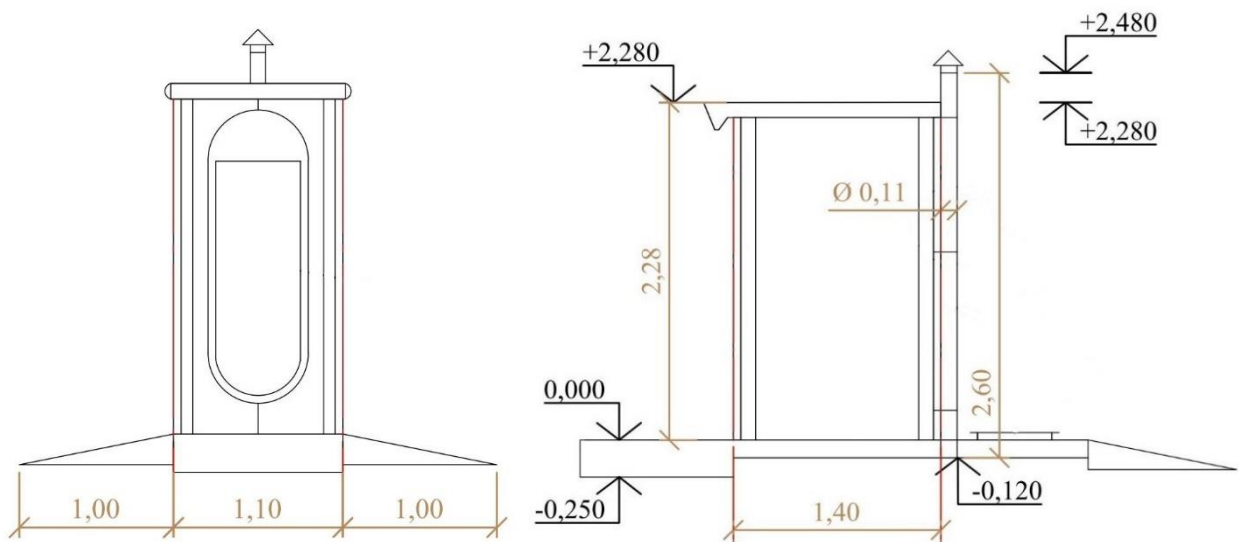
Туалет, выполненный из железобетонных конструкций
